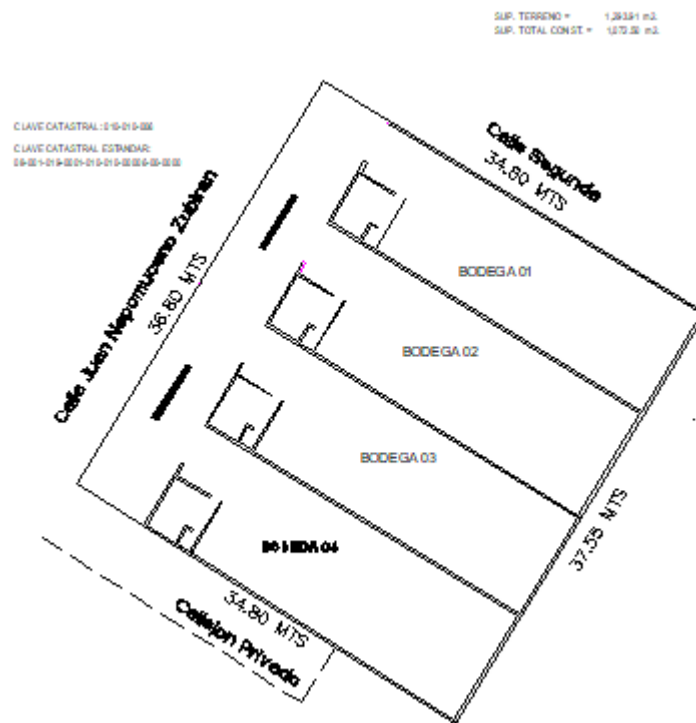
Planta Arquitectónica. Fuente. Elaboración propia
